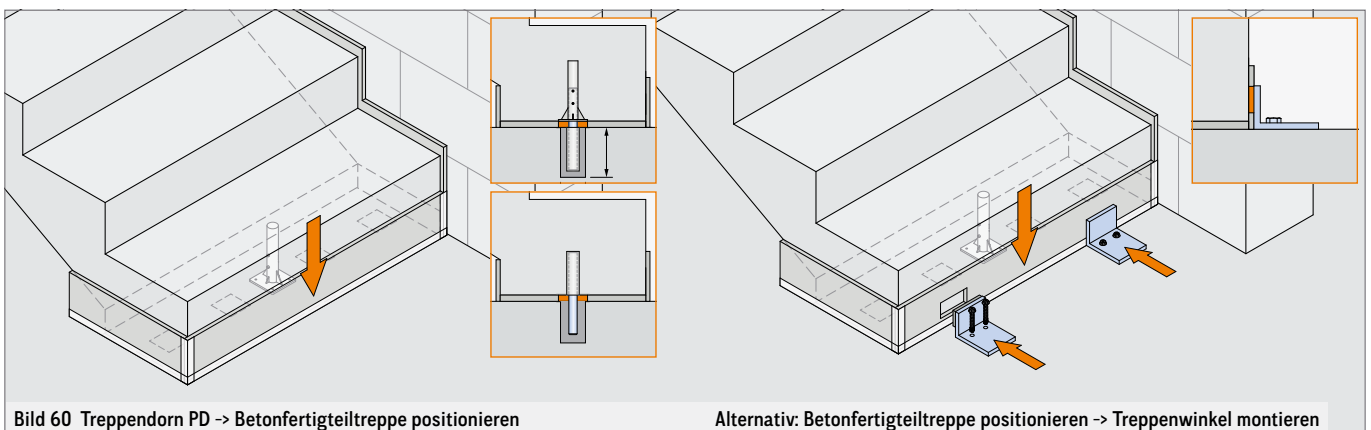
Treppendorn PD -> Betonfertigteilstufe positionieren
